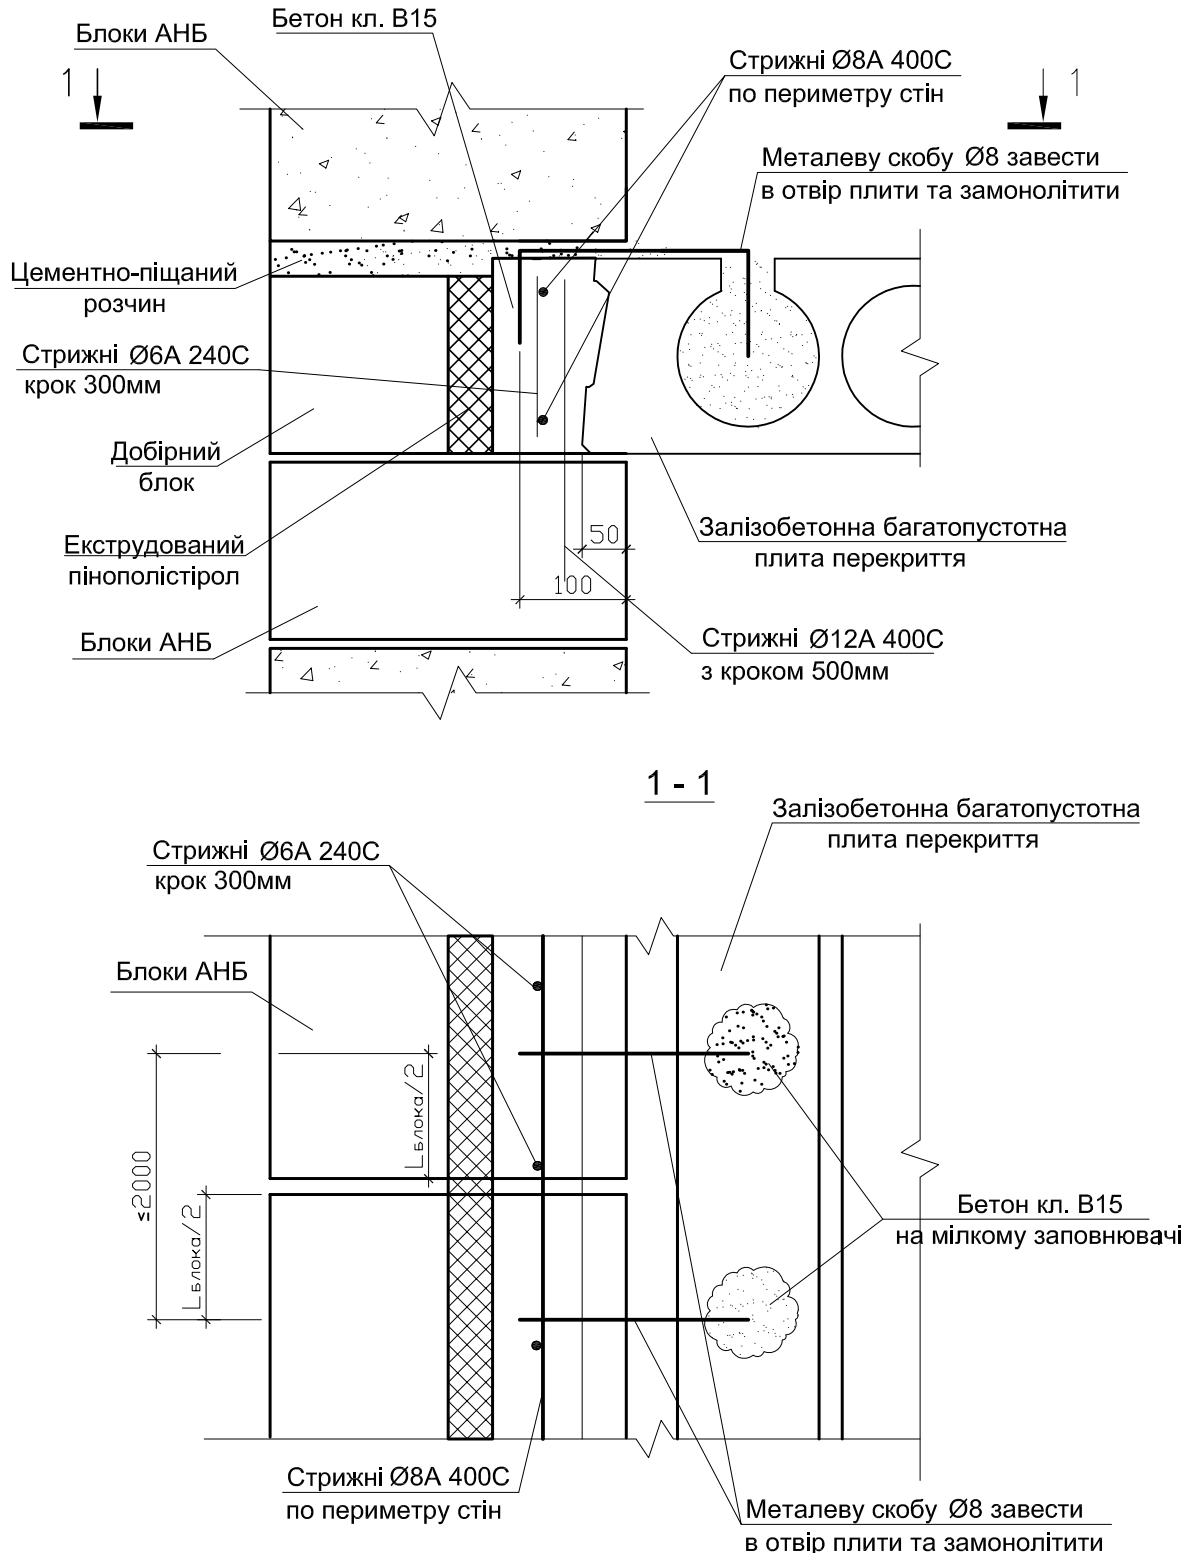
8-7. Анкерування збірних багатопорожнистих плит перекриття
